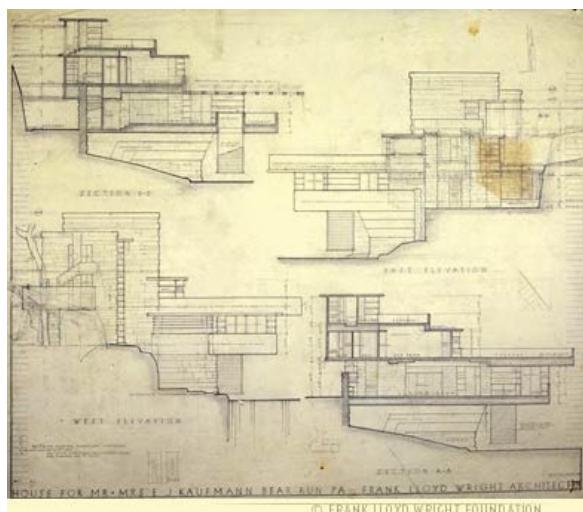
(a) Plantas de cortes originais da Fallingwater.
